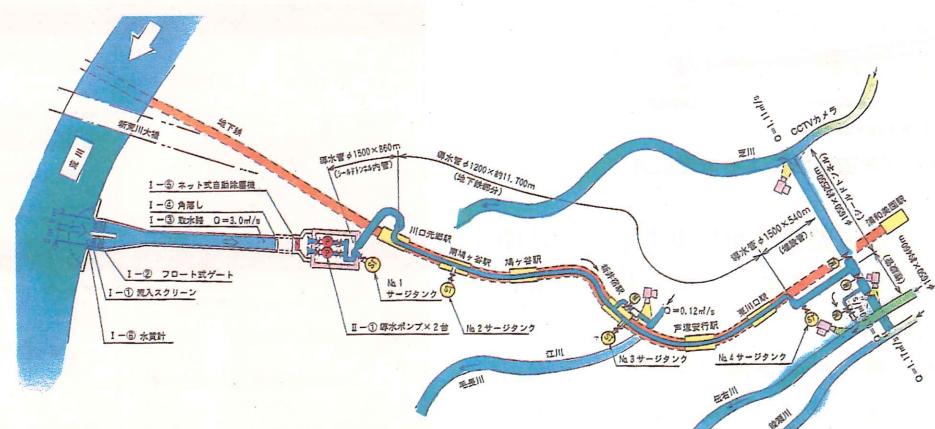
綾瀬川・芝川等の浄化導水設備 全体概要図（平面）
